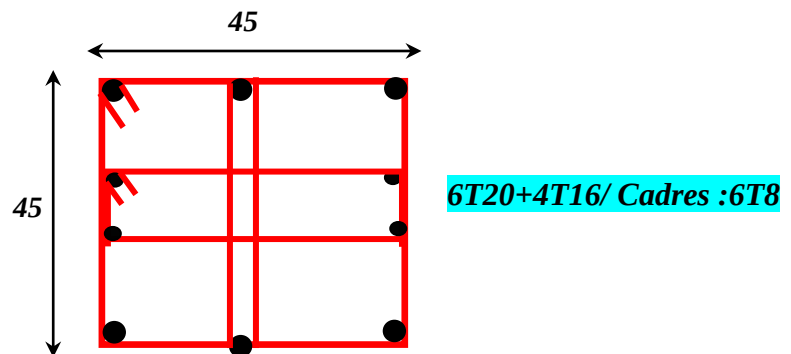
Schéma de ferrailage des poteaux 45×45.
